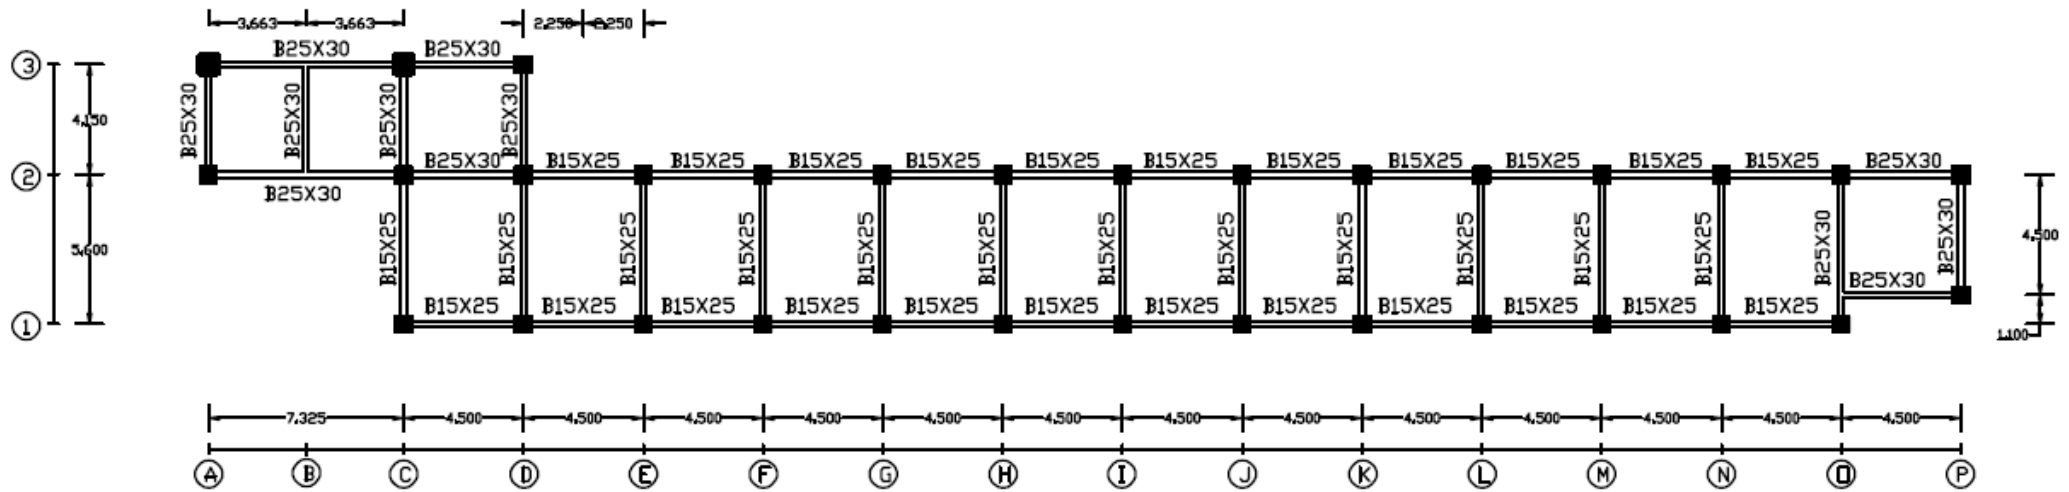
Denah Balok Lantai 1 – 4 *Typical
